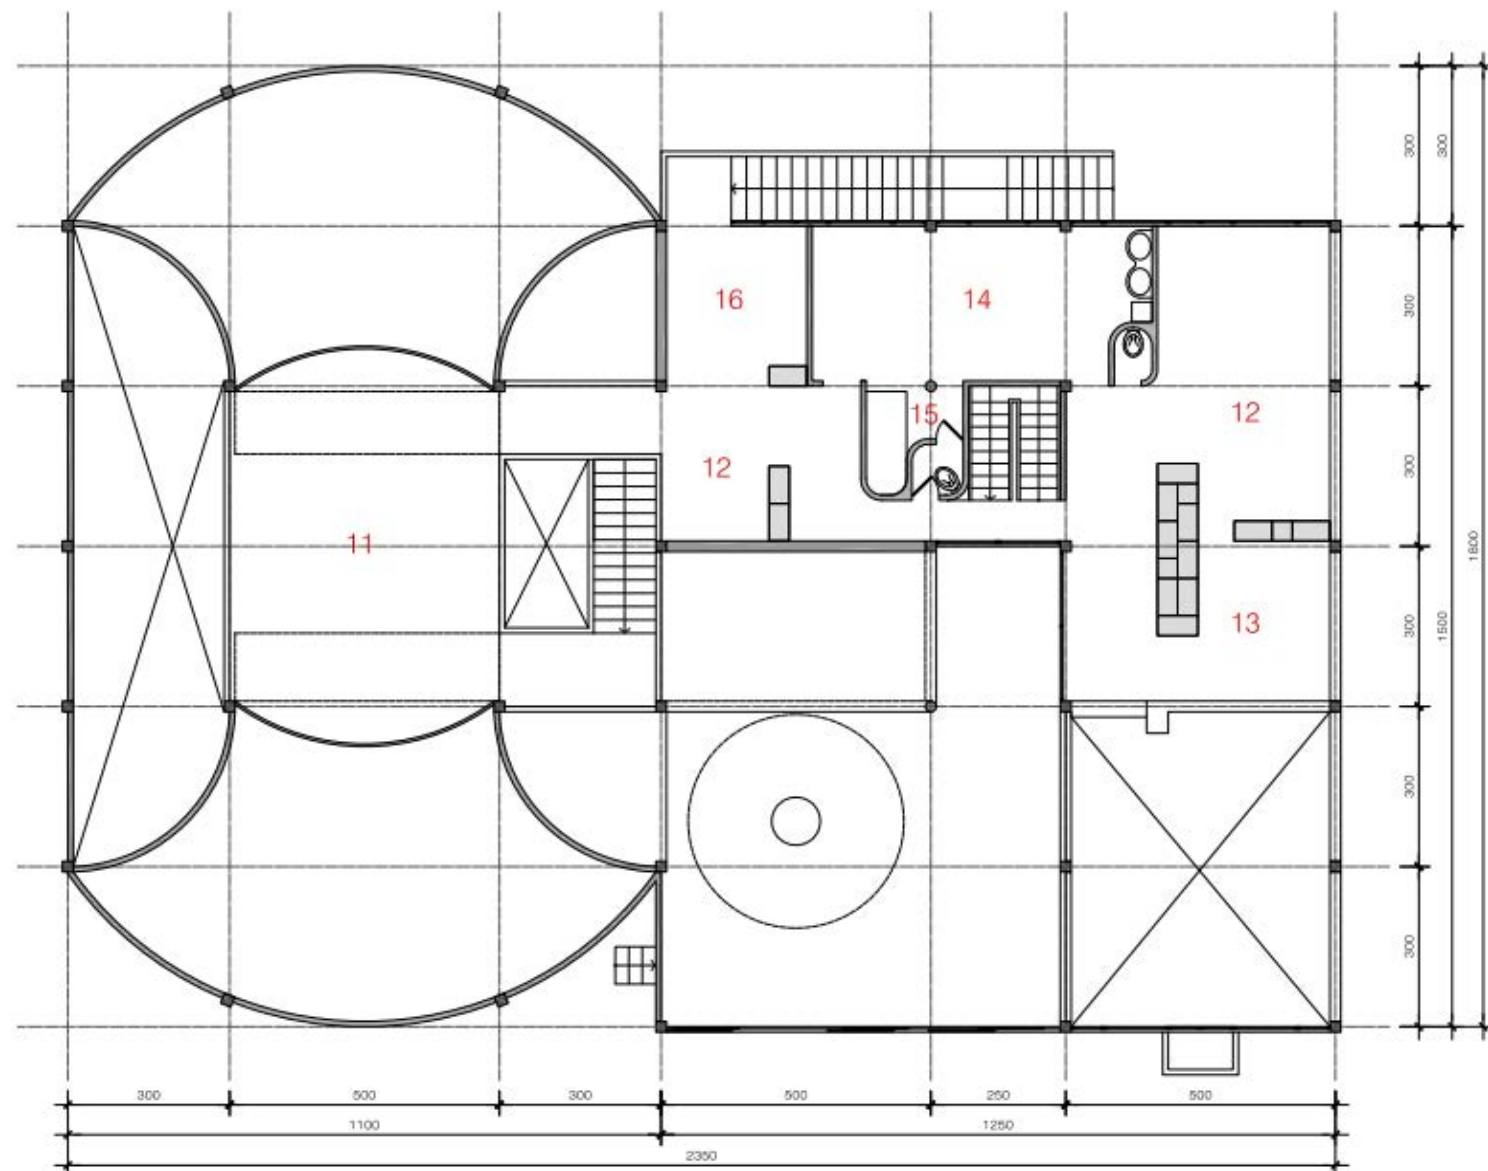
Planta do segundo pavimento, redesenhada por Mônica Luce Bohrer, detalha os ambientes do Pavilhão.
